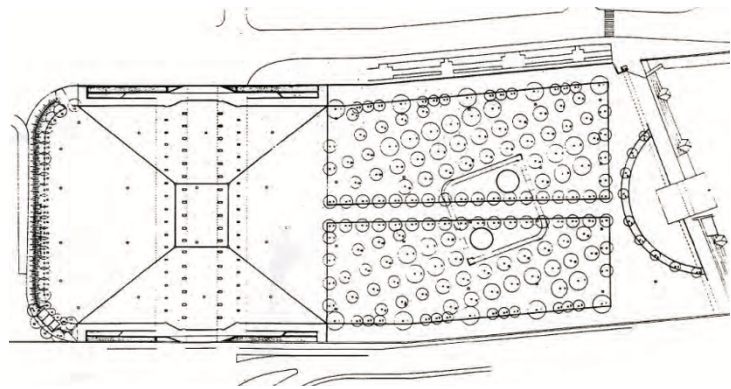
Planta general de la propuesta de Ángel Zurilla (Vigil de Insausti, 2012)
